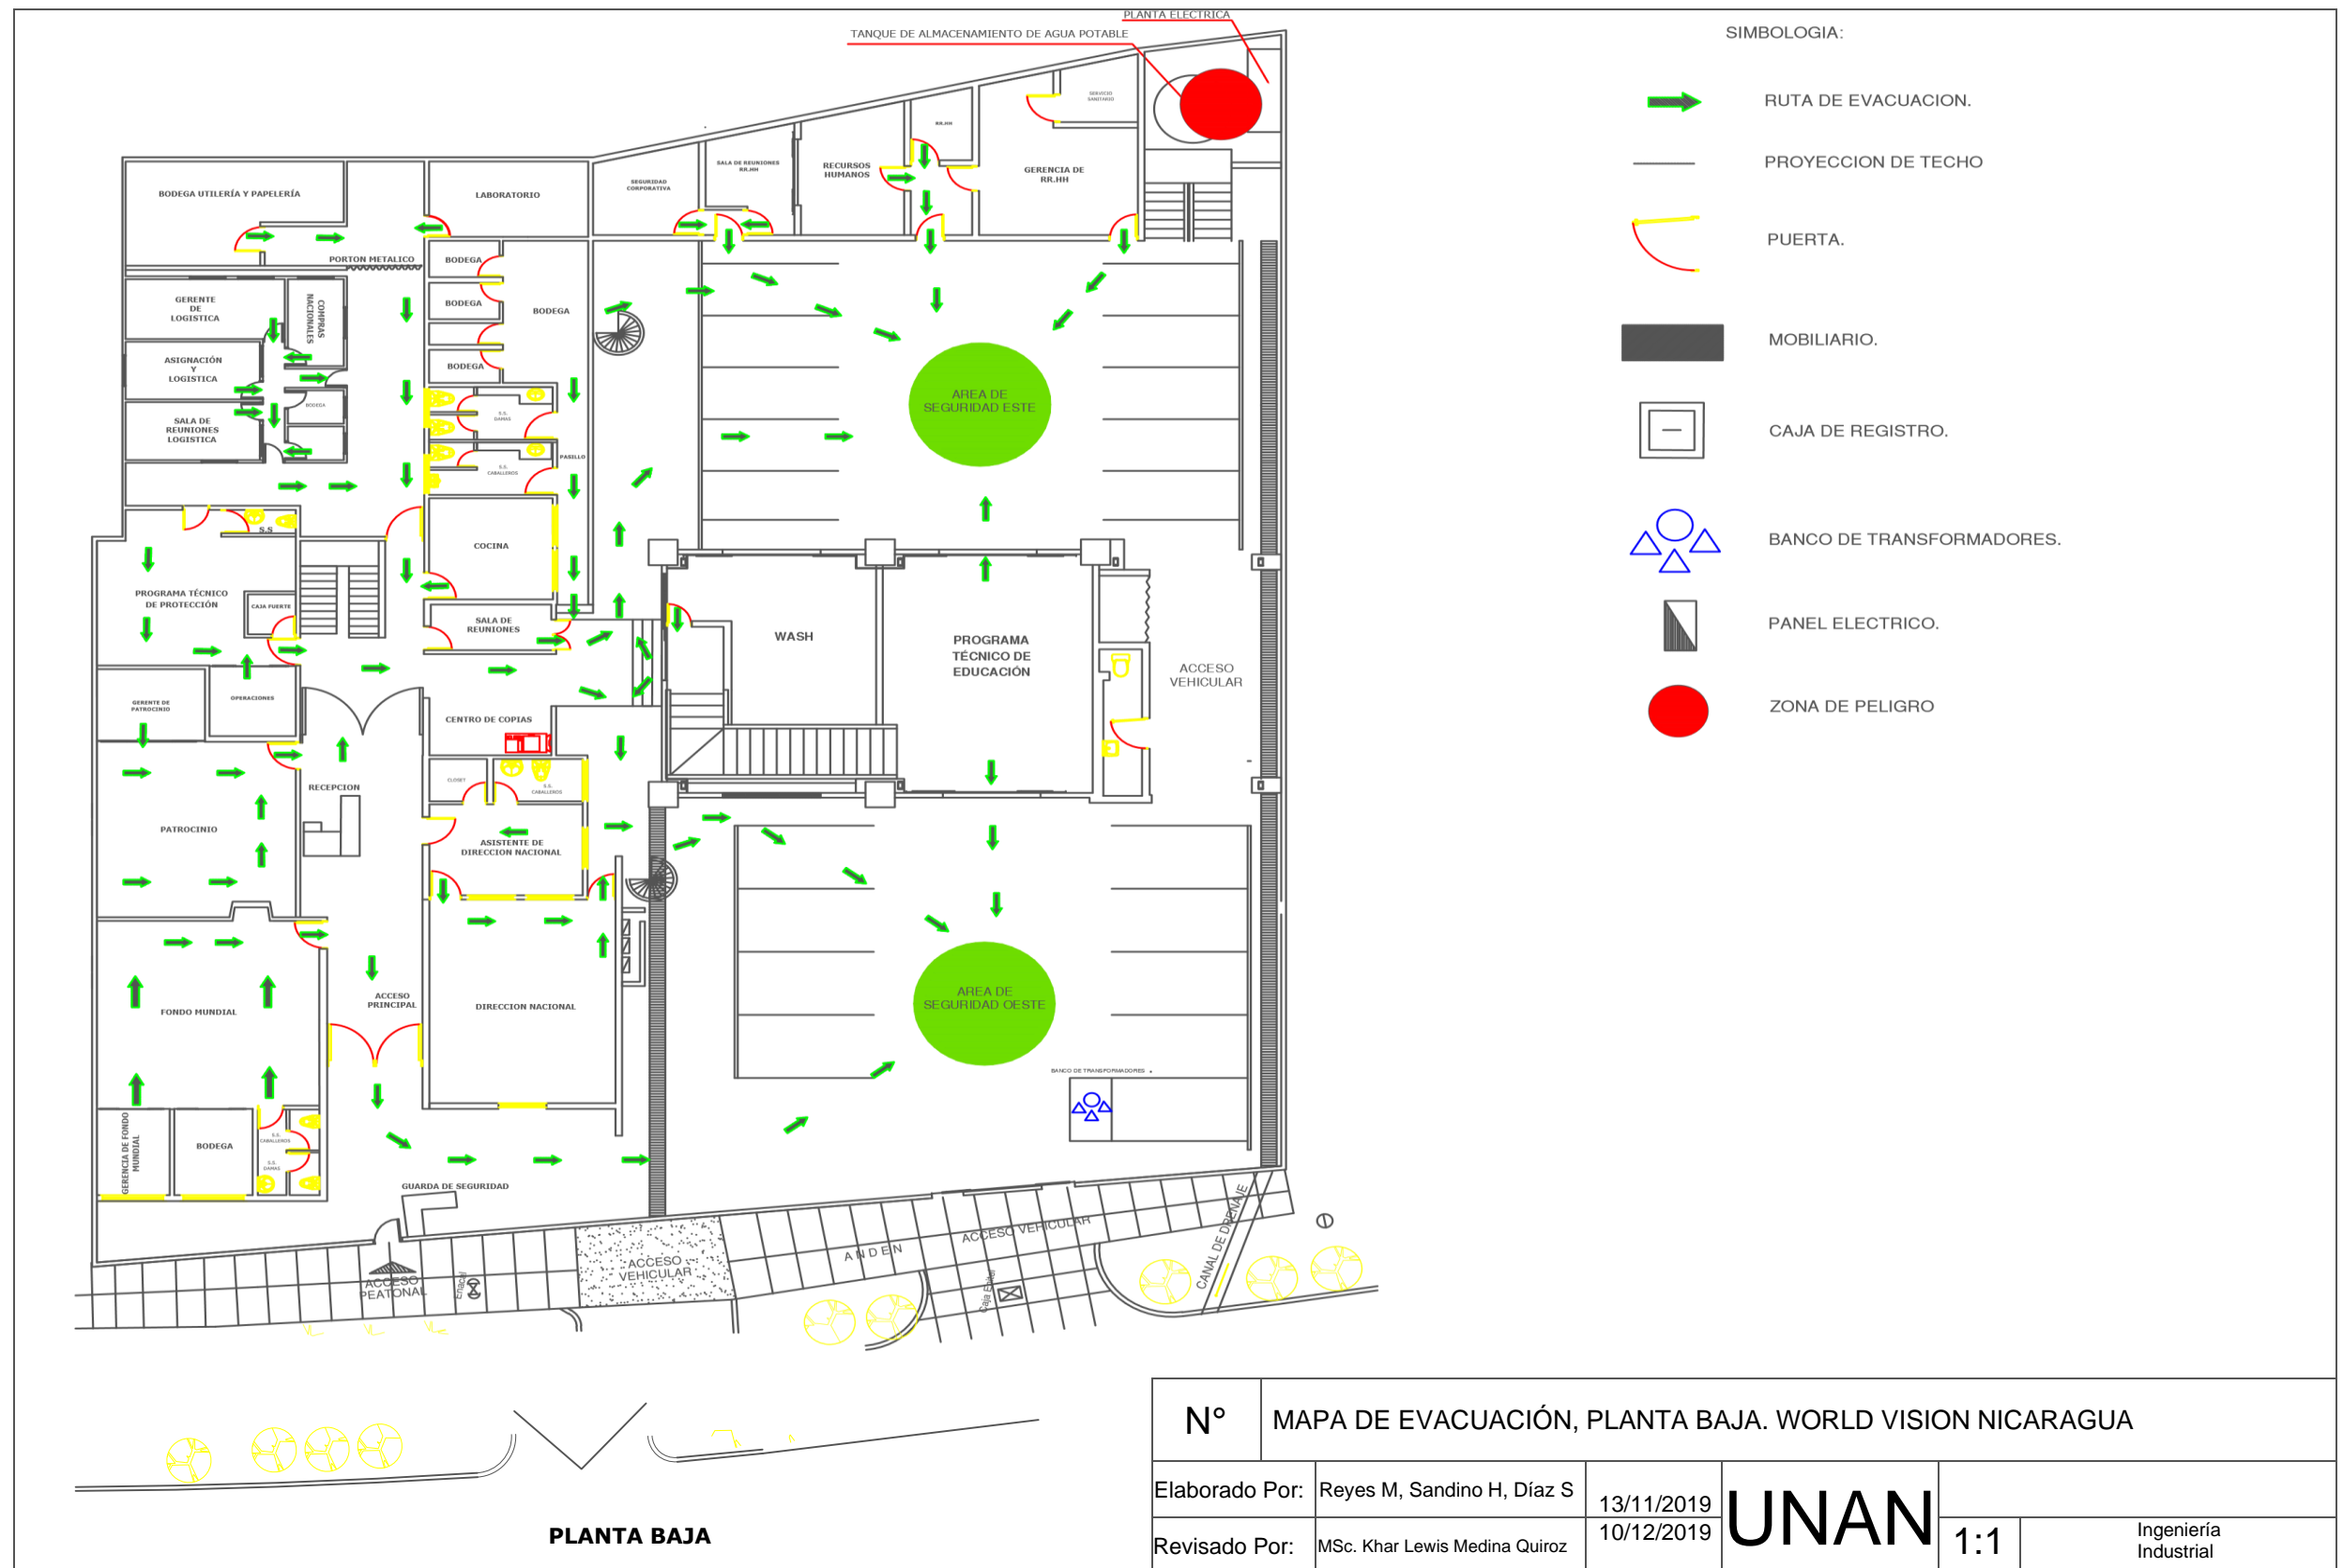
Ruta de Evacuación Propuesta, Planta Baja.
